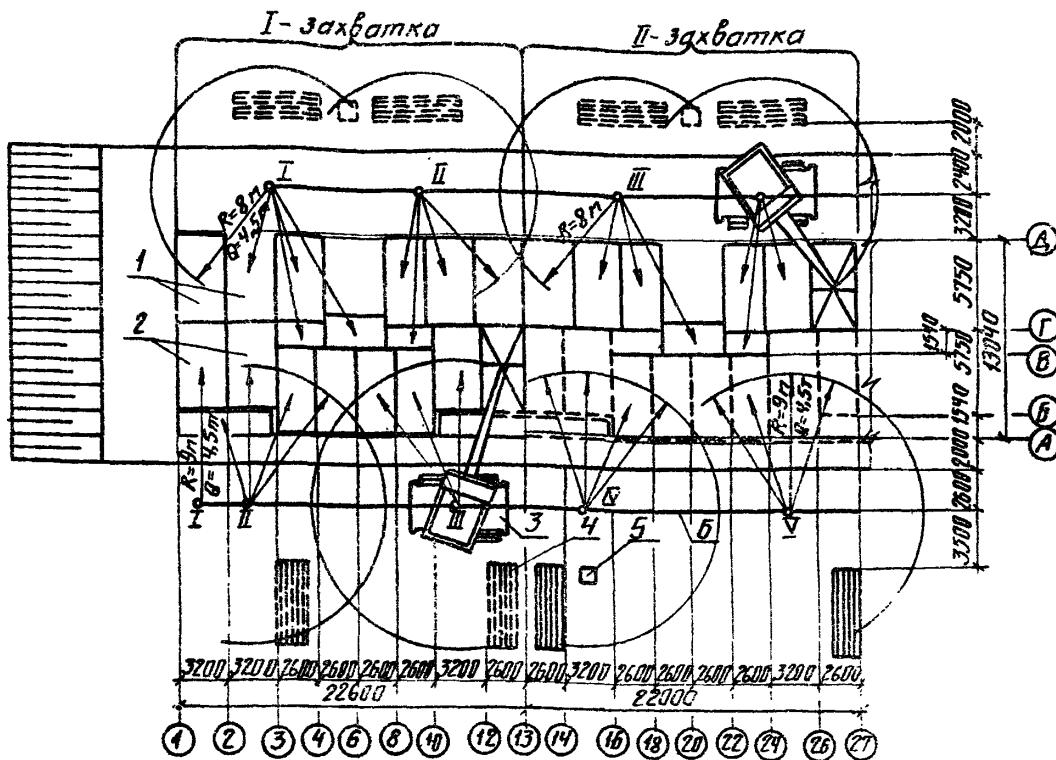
Схема организации работ по монтажу панелей перекрытия технического подполья: 1-панели смонтированные краном № 1; 2-панели смонтированные краном № 2; 3-пневмоколесный кран К-161; 4-панели в кассетах; 5-ящик для раствора; 6-ось движения крана; I, II, III, IV, У - стоянки крана
